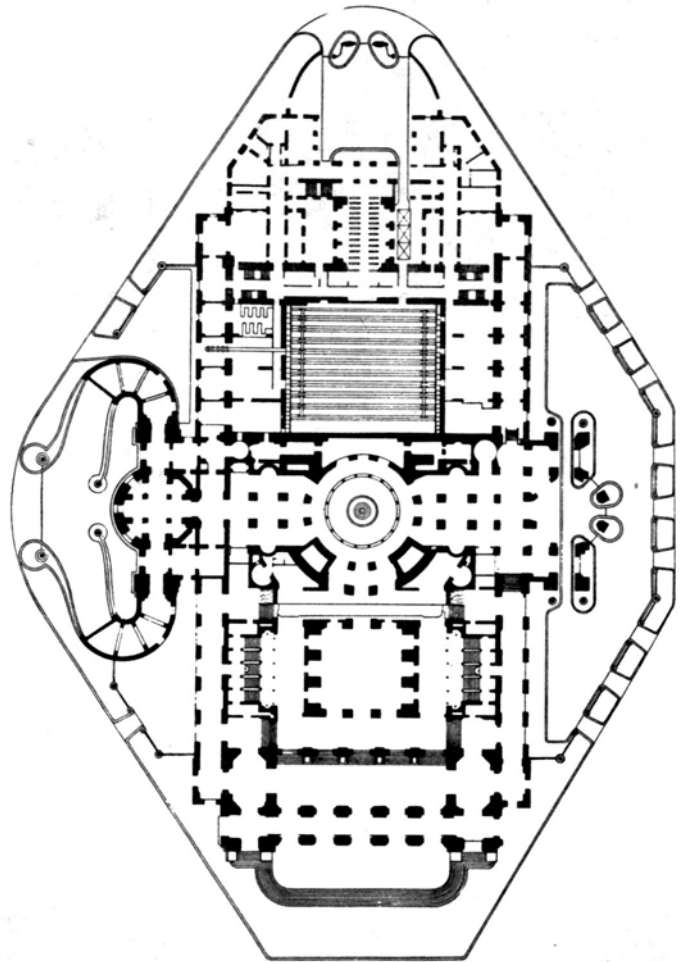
Planta de la Opera de París, proyectada por Charles Garnier y construida de 1861 a 1875.
